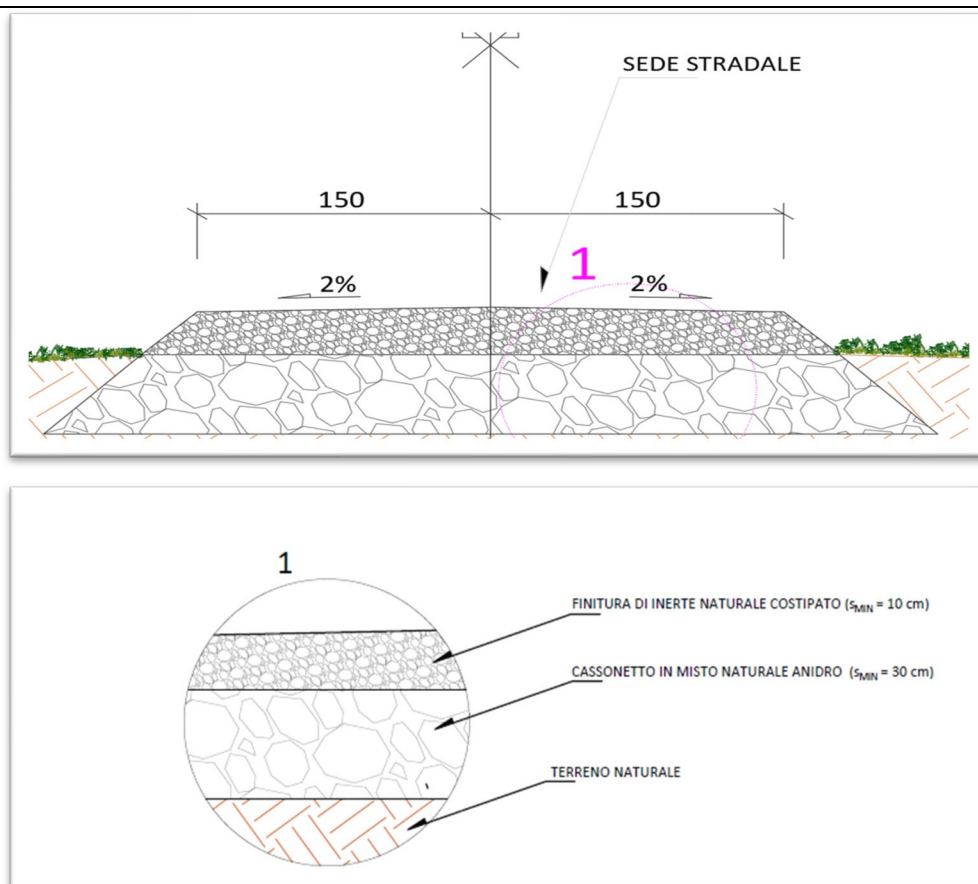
Estratto Elab. R.12 Sezione tipo stradale
